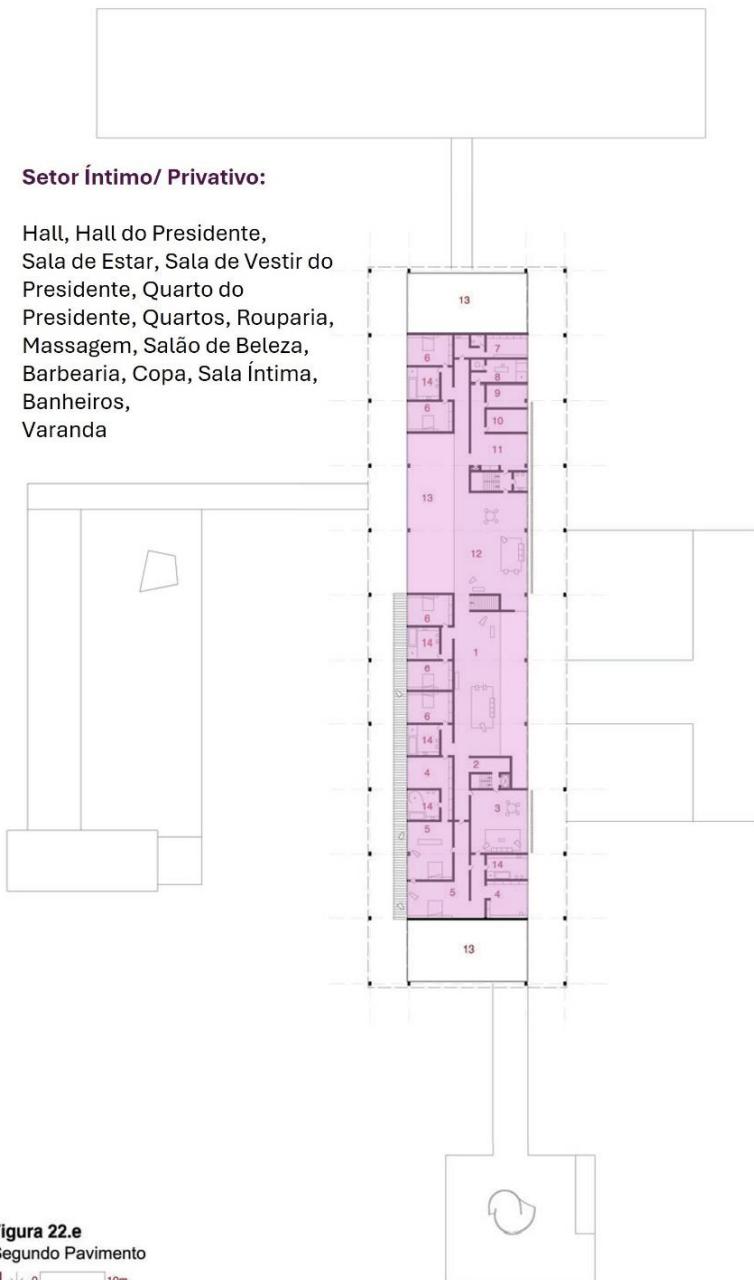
Planta baixa do segundo pavimento do Alvorada (Élcio Gomes, 2012).
